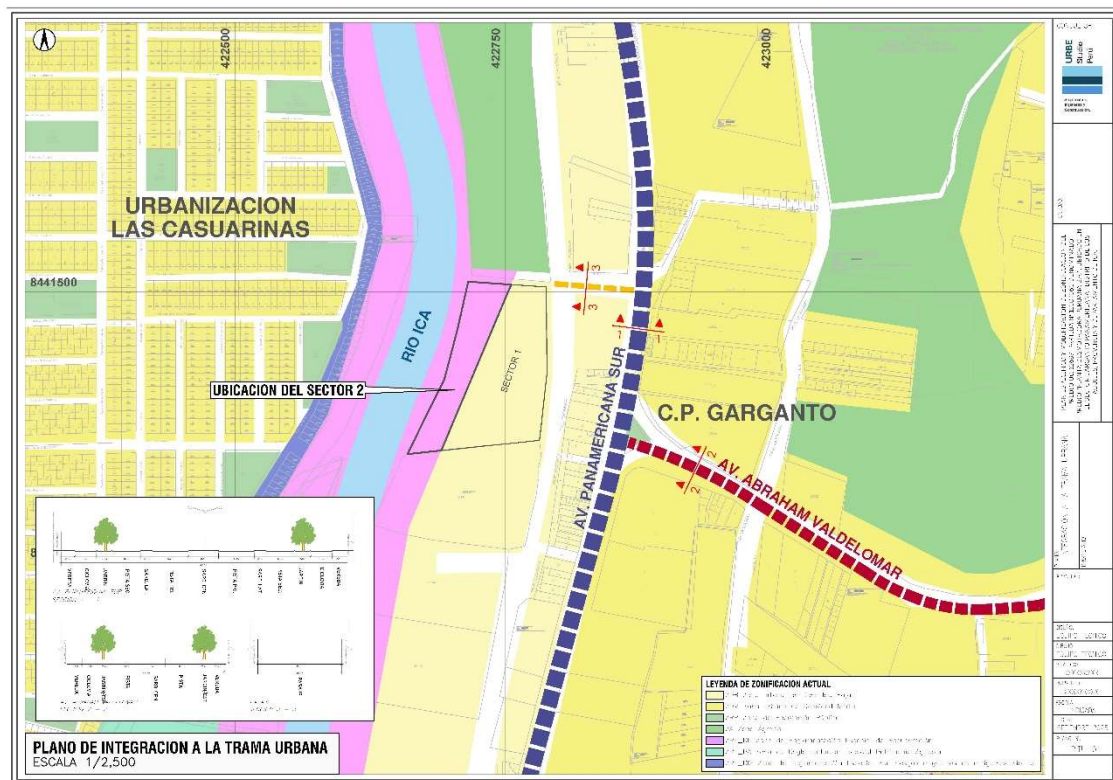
PLANO DE VIAS -SECTOR 2
